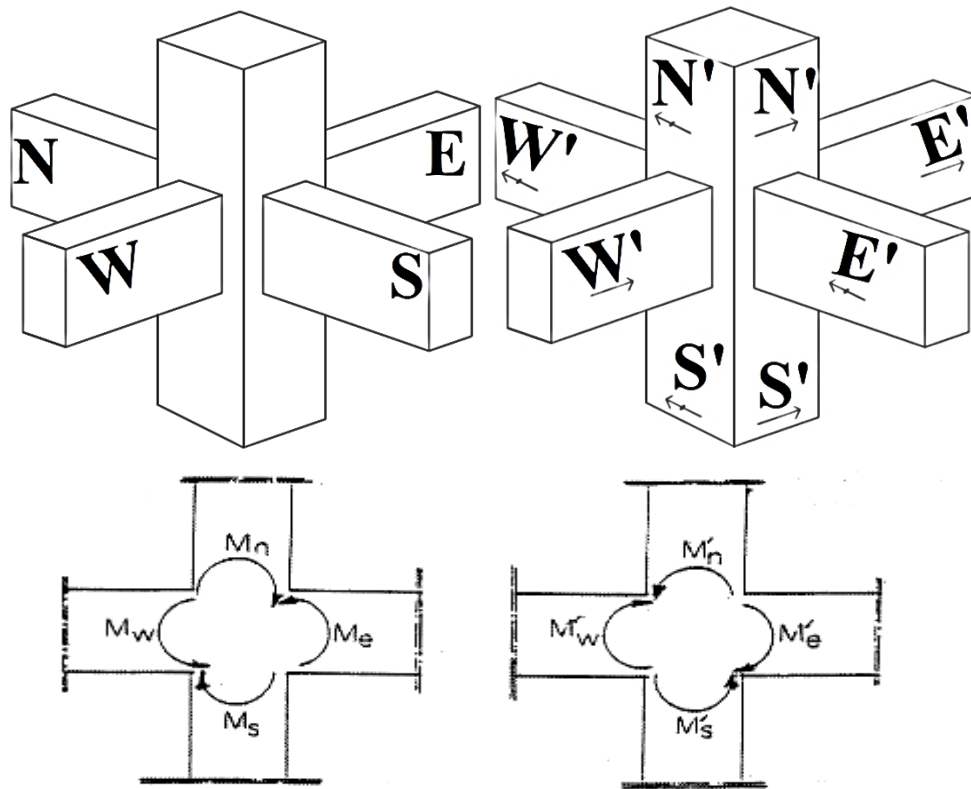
Dimensionnement des nœuds poteaux-poutres
